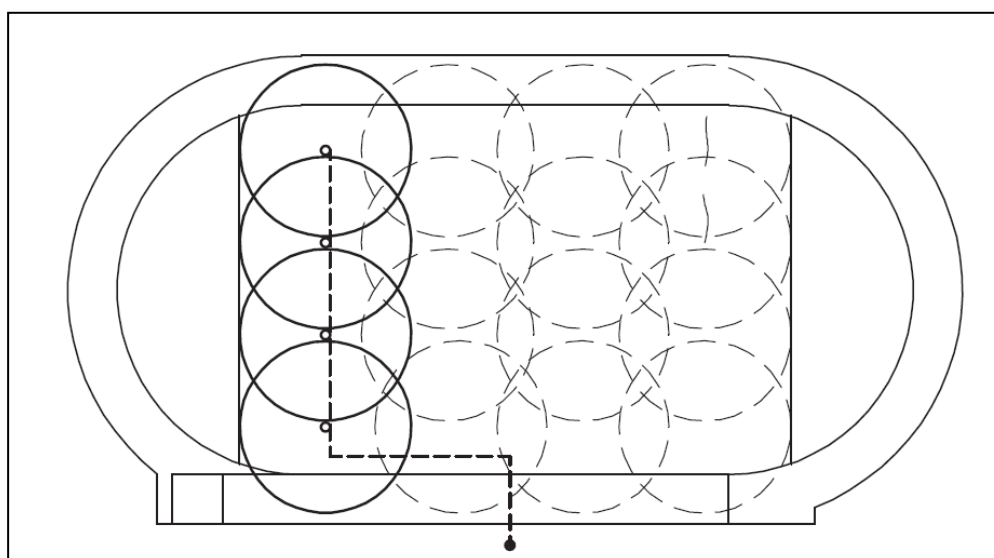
b : Arroseurs sur des tuyaux sous pression installés temporairement
